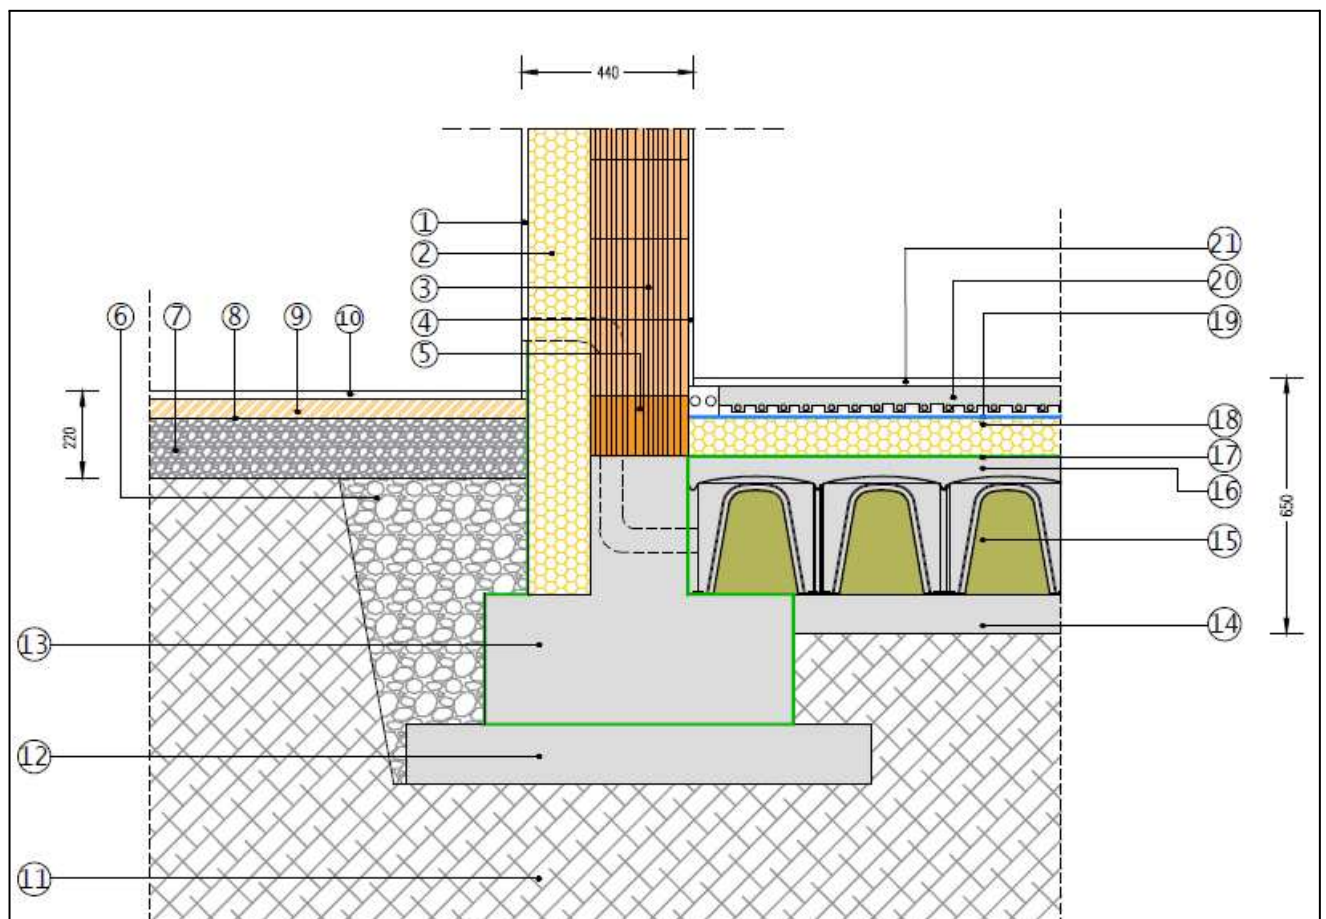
Sistema a telaio in C.A. nodo fondazione-parete perimetrale-solaio controterra-pavimentazione esterna
